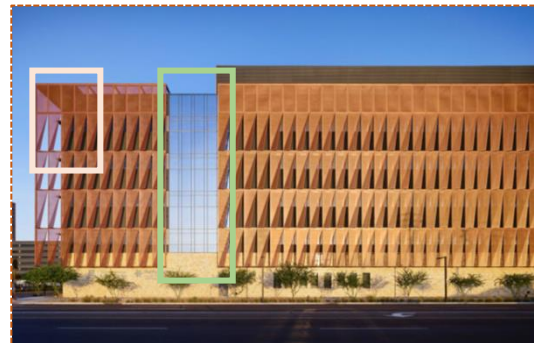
Photo présente le verre et aluminium en façade. [Source : <https://www.archdaily.com>].
